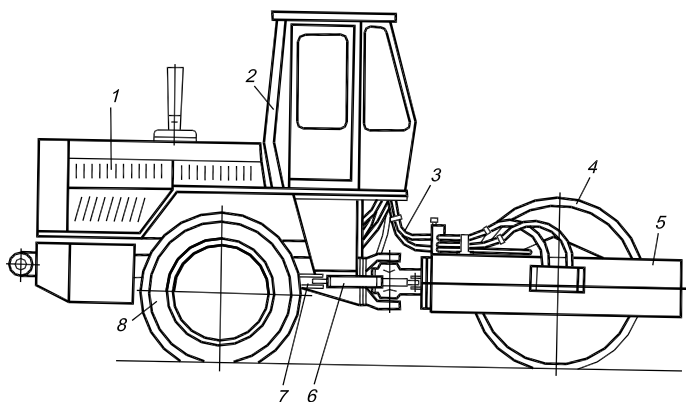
Общий вид самоходного катка ДУ-57-1
